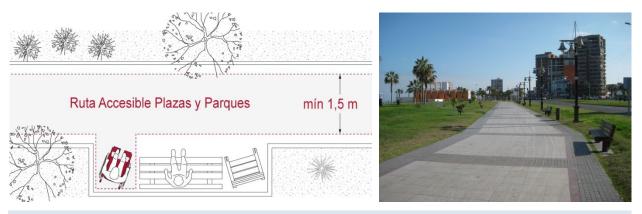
Rutas accesibles en plazas y parques de ancho mínimo 1,5m. Foto 3 (der): Ruta accesible de pavimento estable en parque.
